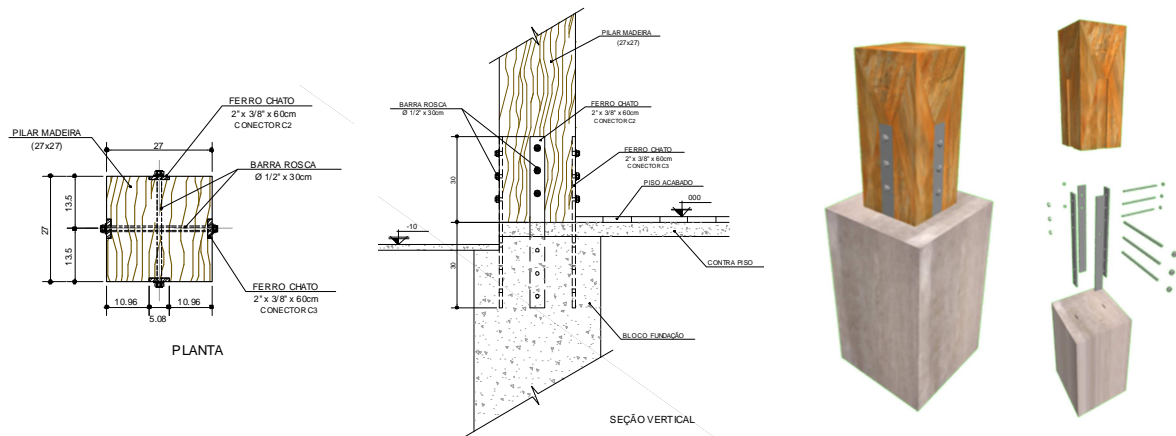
Edificação Sosas – Projeto e modelo tridimensional da interface pilar-fundação. Fonte: Elaborada pelos autores.
